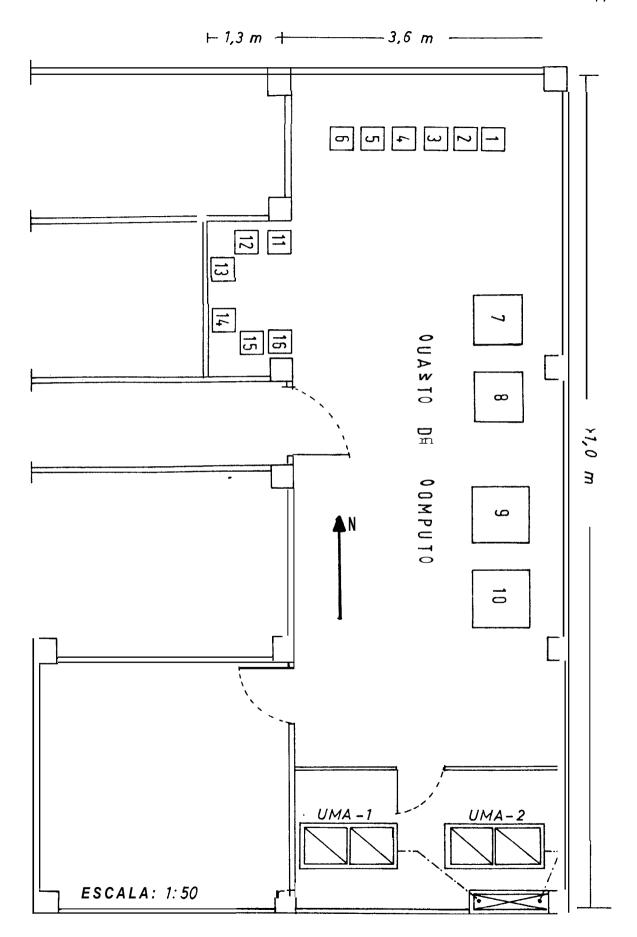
VISTA EN PLANTA DEL CENTRO VE COMPUTO.
